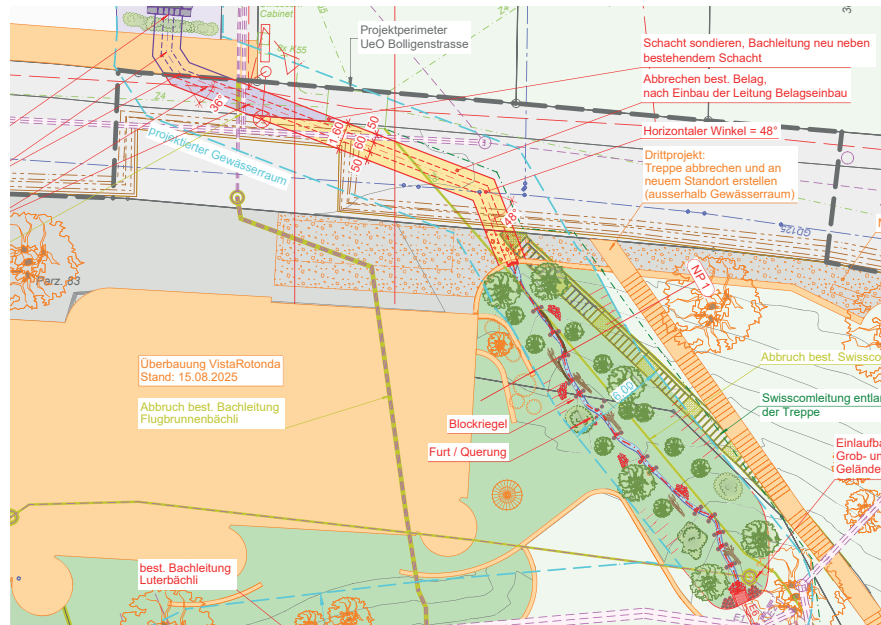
Wasserbauprojekt, Stand 2. öffentliche Auflage (September 2025)
